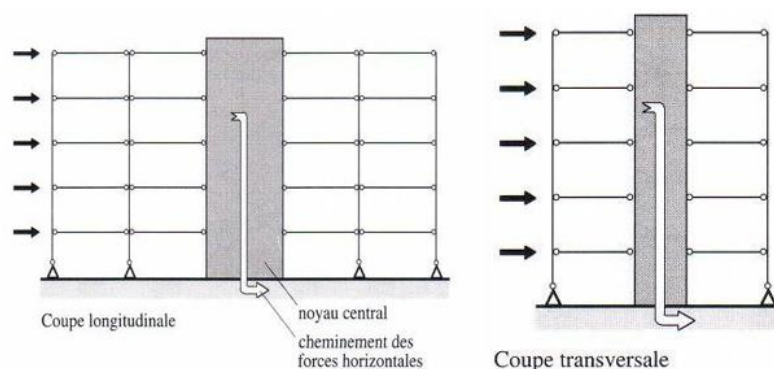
Coupe longitudinale et transversale d'une structure contreventée par noyau central.
